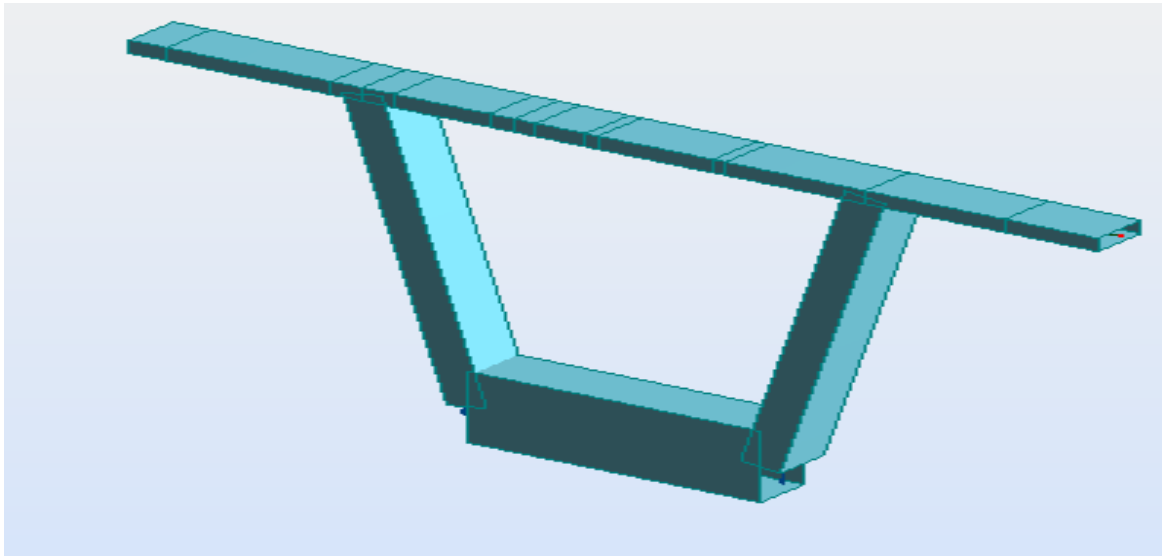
Modélisation de la section transversale (sur pile).
